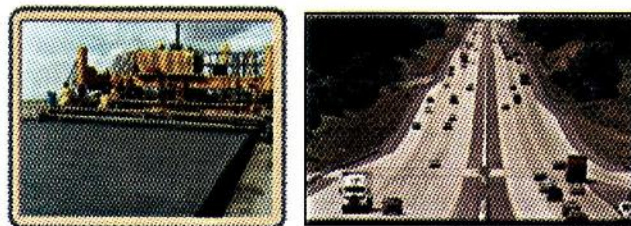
Pavimentos rígidos tradicionales en el campo de la Ingeniería Civil.
